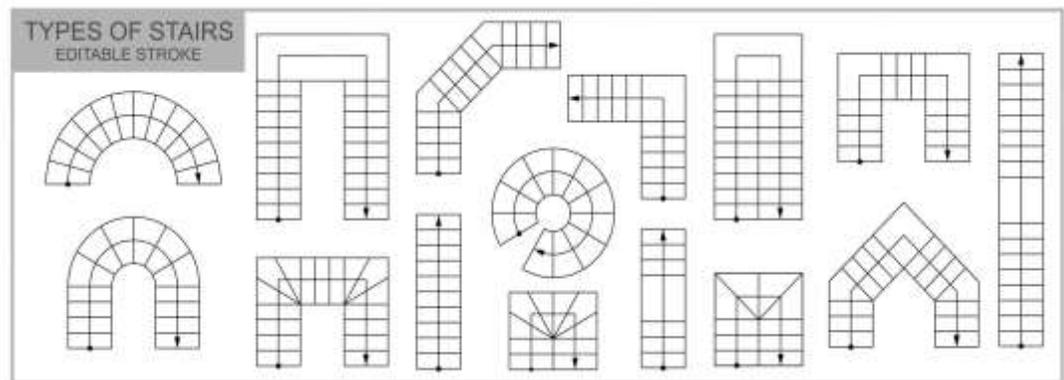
Espacio bidireccional (Vista en planta de distintos tipos de escaleras)
